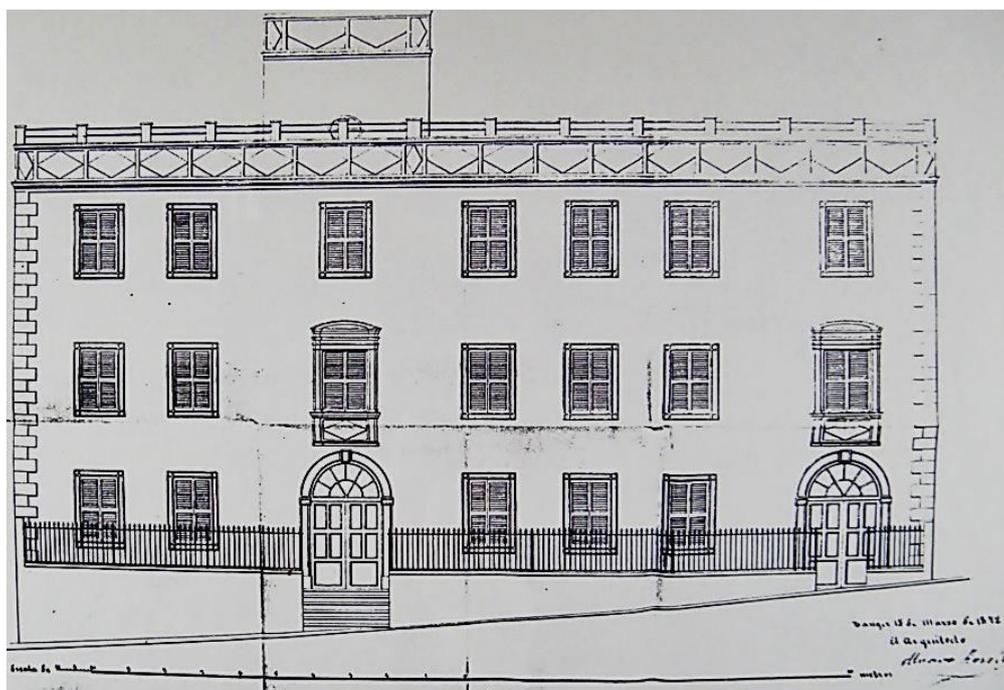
Fachada de la legación de Suecia, alzado elaborado por Álvaro Rossell (ADT, Caja 538)
